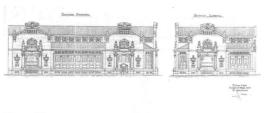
Proyecto de Mercado. Fachadas principal y lateral.
